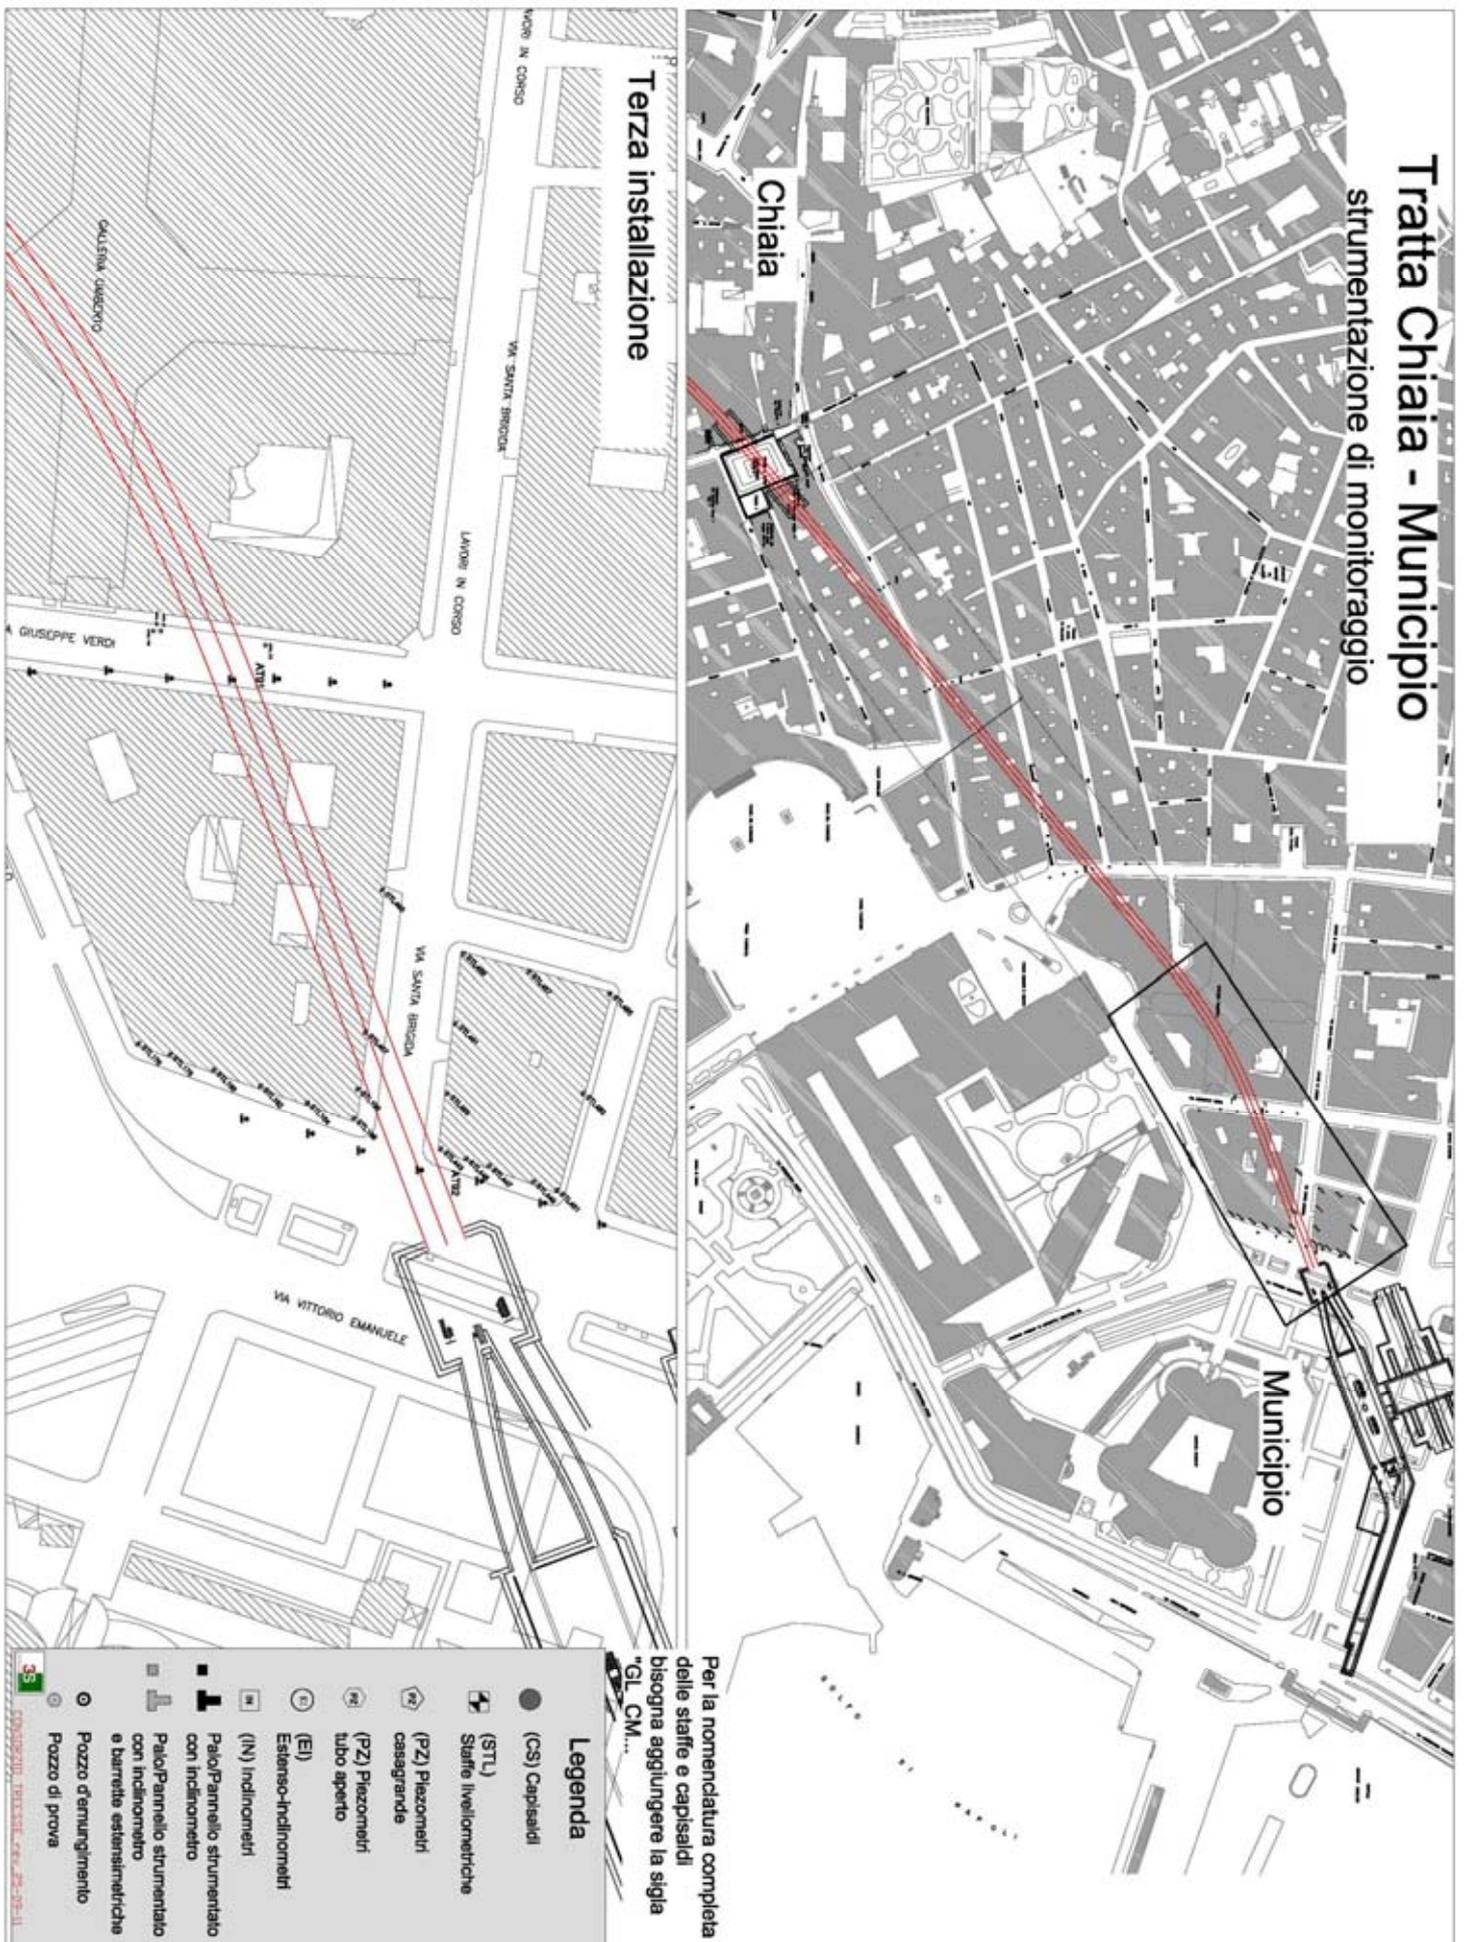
Planimetria tratta Chiaia - Municipio, raffigurante la disposizione della terza installazione della strumentazione di monitoraggio.
